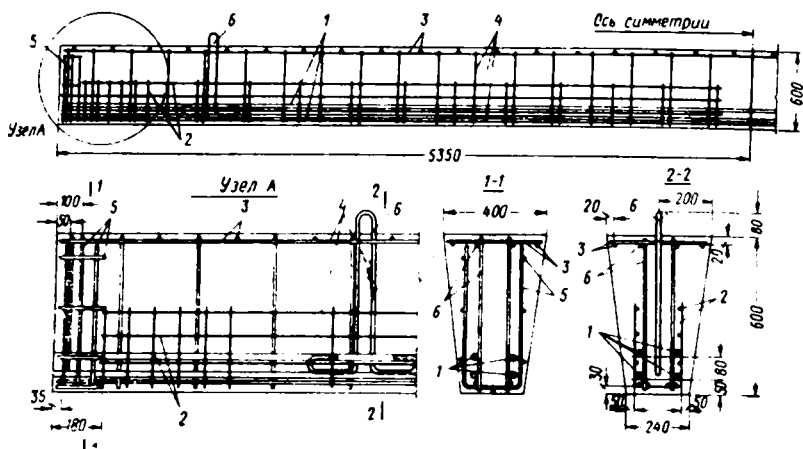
Типовая фундаментная балка при колоннах с шагом 12 м
